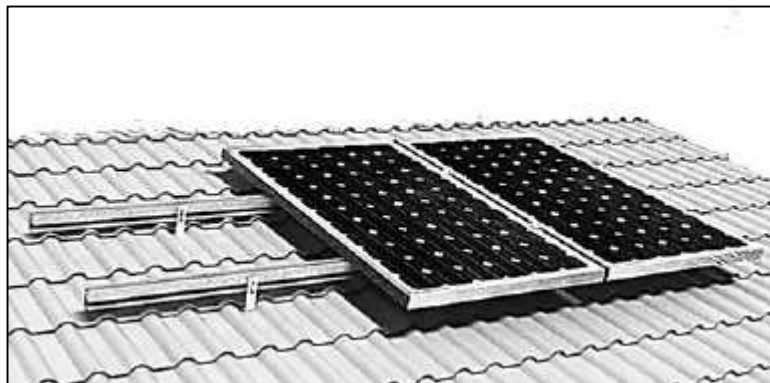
Detalhe das presilhas e perfil do suporte.
